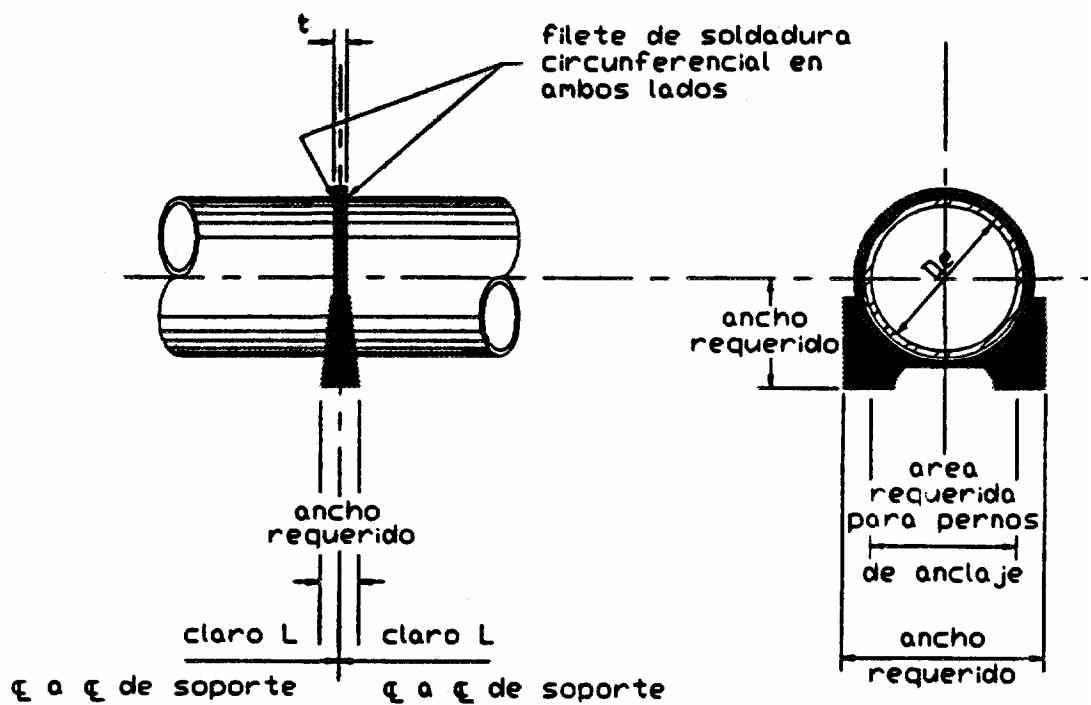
Detalle de soporte tipo anillo rigidizante para tubería pequeña
